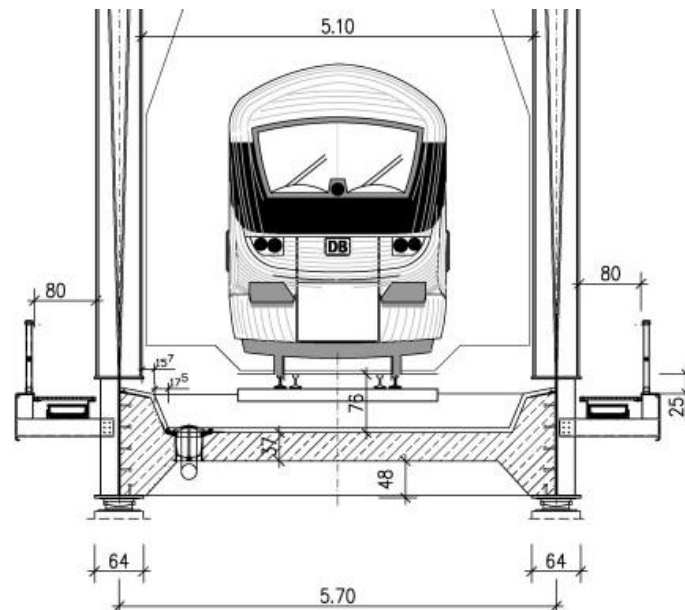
Beispiel für ein I-Profil mit schlaff bewehrter Platte (Verbunduntergurt) [2]
